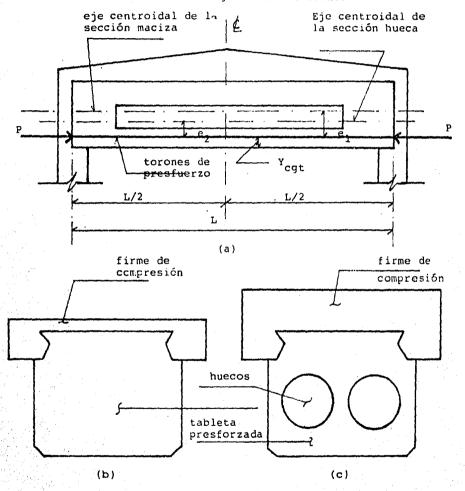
Tableta presforzada de sección compuesta y aligerada a) Corte longitudinal, b) Corte tranversal en el extremo, c) Corte transversal en el centro.
